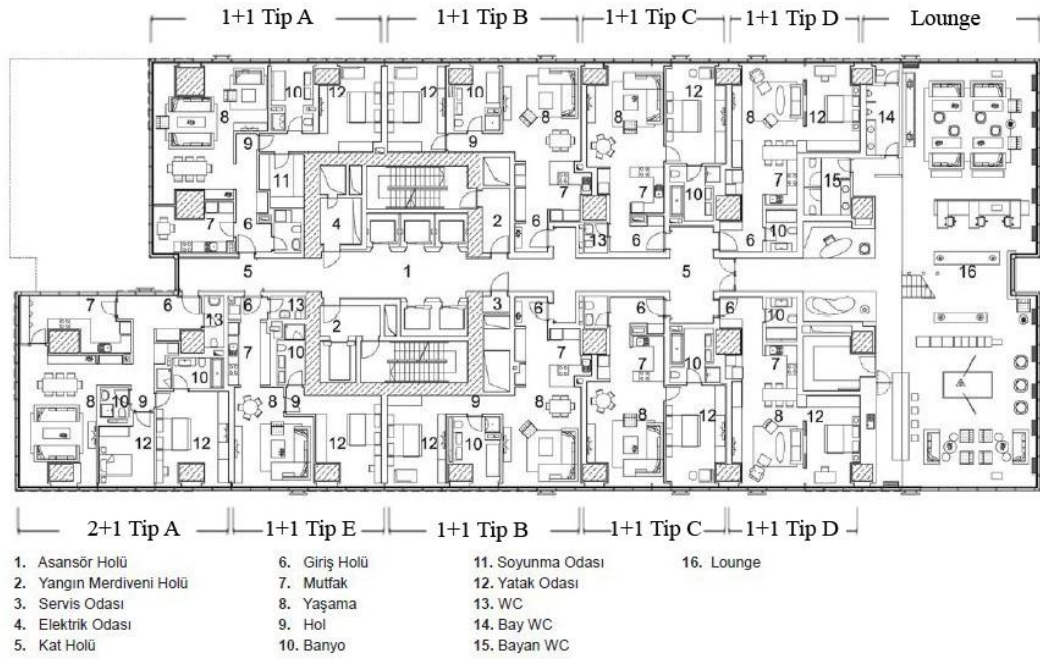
Polat Tower Residence Tipik Konut Katı Planı
